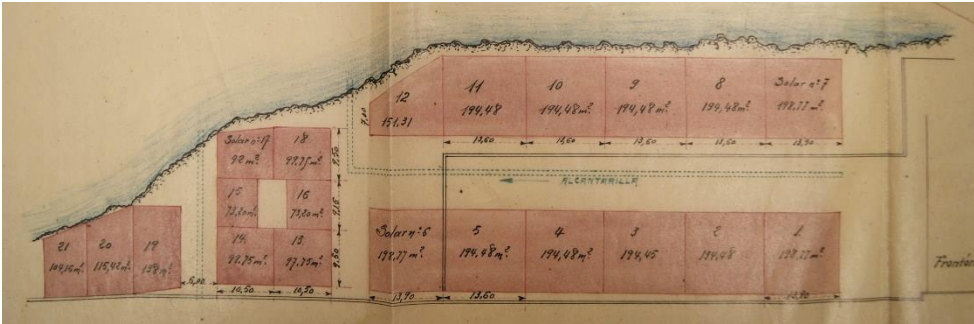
Planta del proyecto de ensanche por el frontón. 1904.. (AMB 1904)
